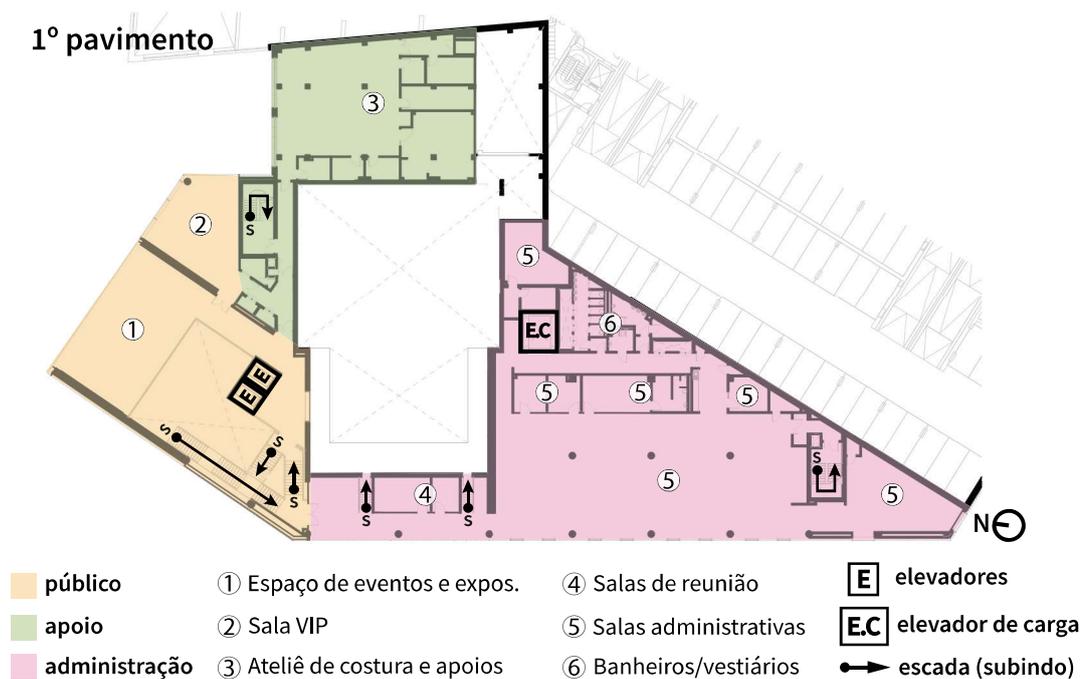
planta do 1º pavimento. Fonte: *ArchDaily* com intervenções da autora
